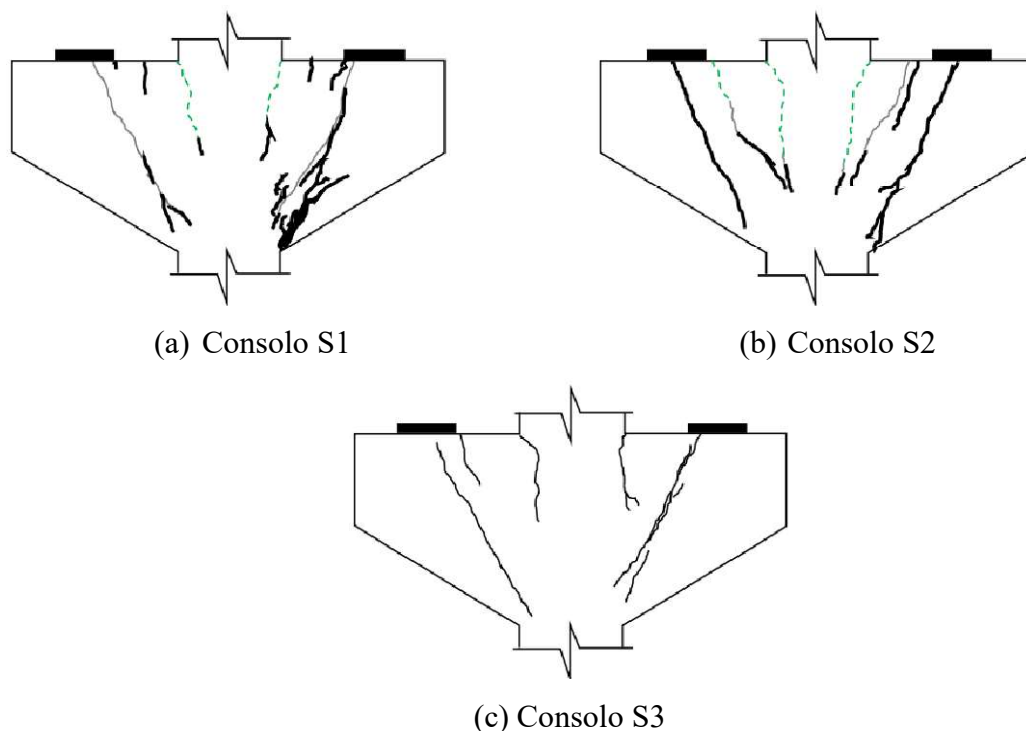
Fissuras observadas nas peças ensaiadas.
